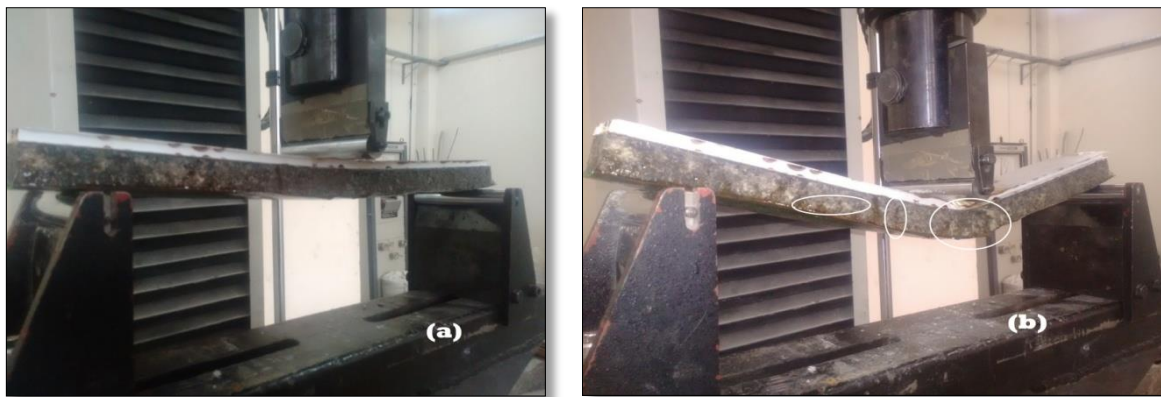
Essais de flexion 3-points : (a) début de l'essai ; (b) rupture de l'âme et la semelle inférieure après fissuration.
